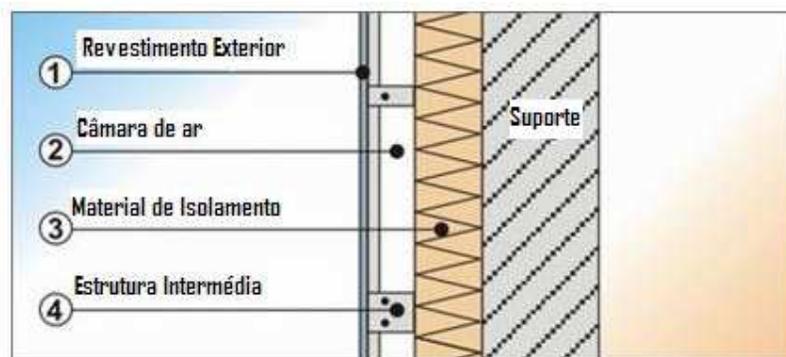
Esquema de um Sistema de Fachada Ventilada [33]
